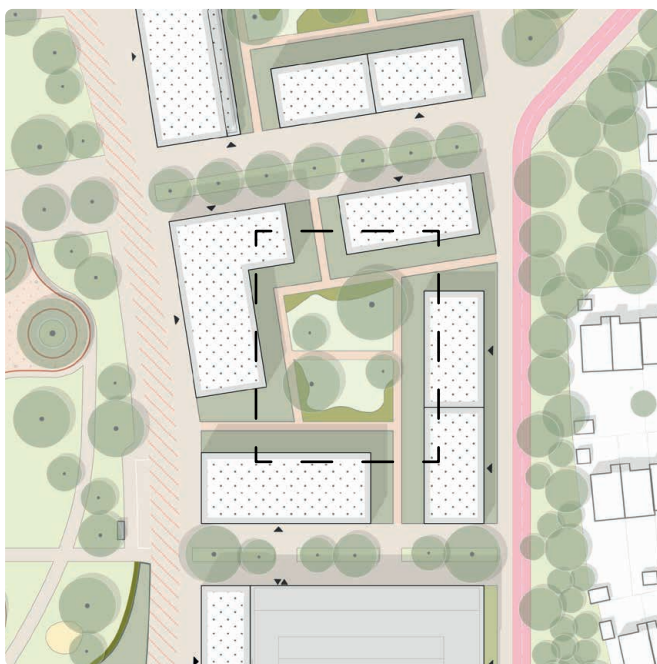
Verortung Lageplanausschnitt Innenhöfe
